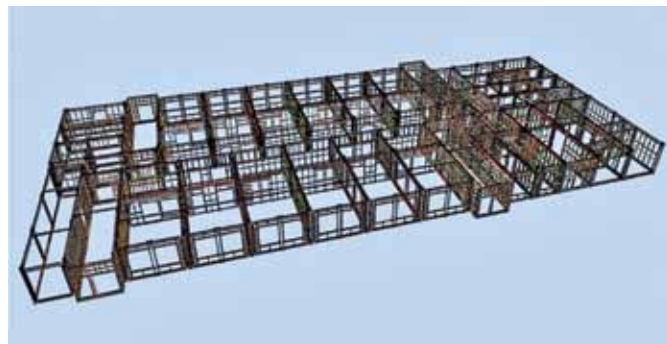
3D-модель здания из железобетонных крупногабаритных модулей на платформе BIM
